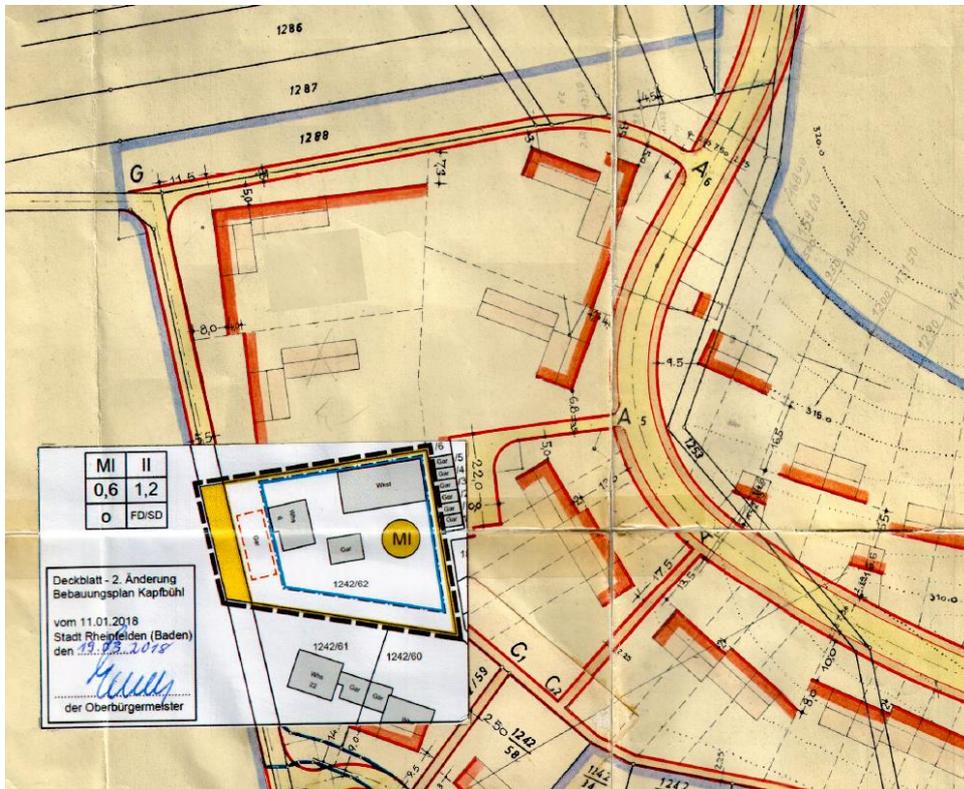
Straßen- und Baufluchtenplan mit 2. Änderung als Deckblatt
